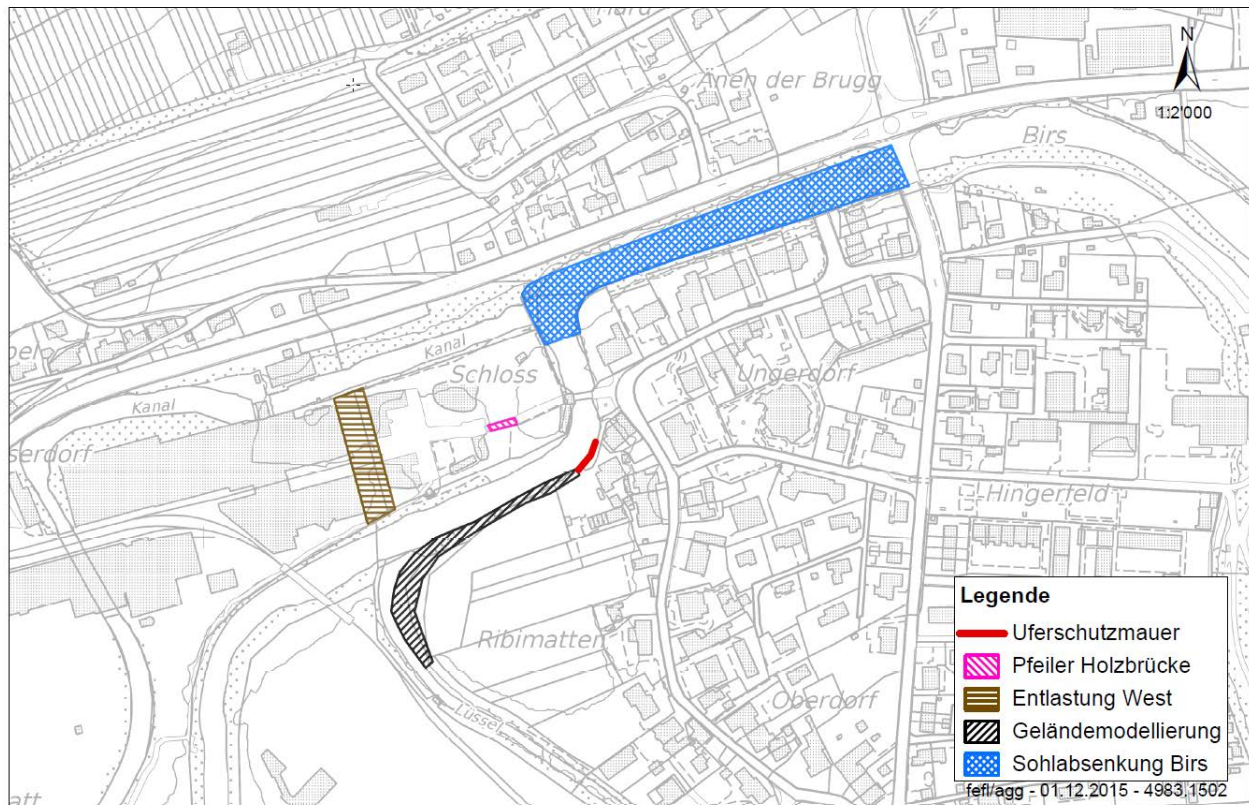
Situationsplan inkl. bauliche Massnahmen
